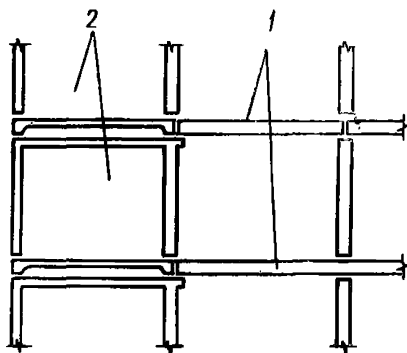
Схема опирания панельных перекрытий на объемные блоки (фрагмент продольного разреза здания)
